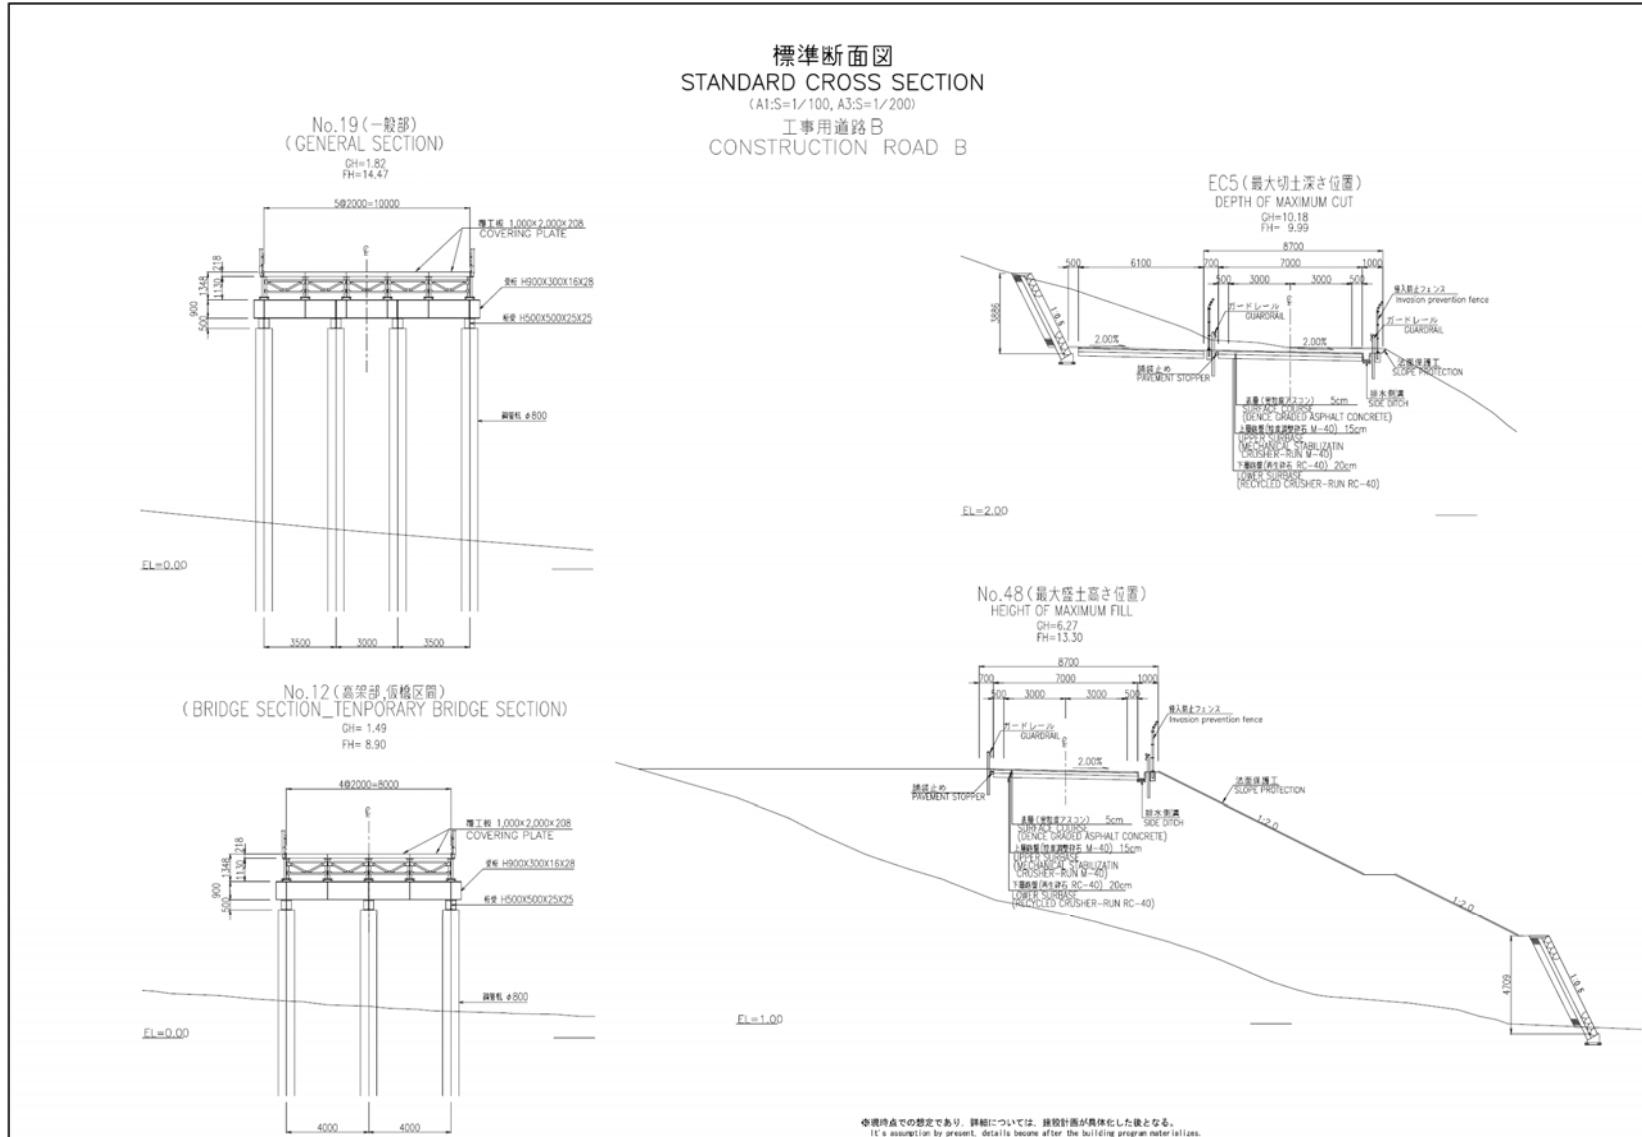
(2) 工事用仮設道路標準断面図 (B 区間)
